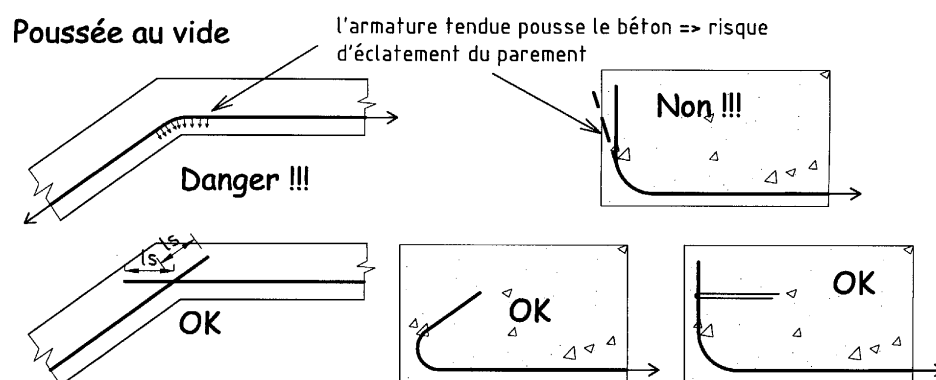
Dispositions constructives à mettre en œuvre pour se prémunir des désordres dus à la poussée au vide.
